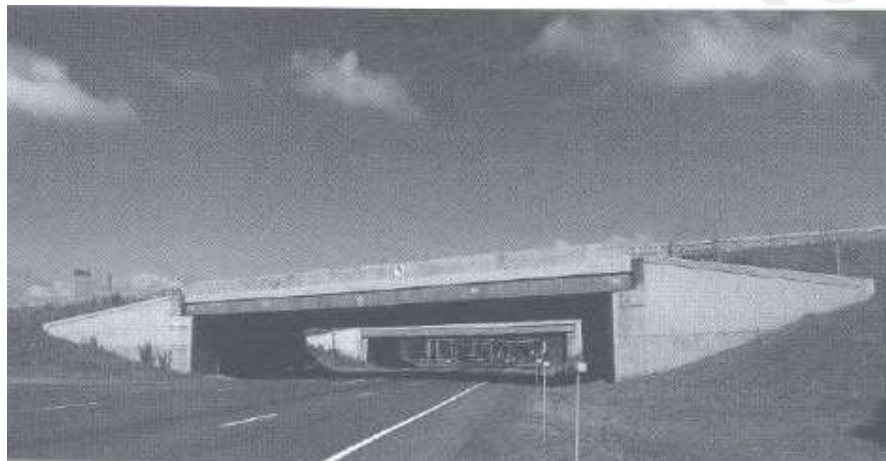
Las estructuras a desnivel típicas con pilares cerrados
